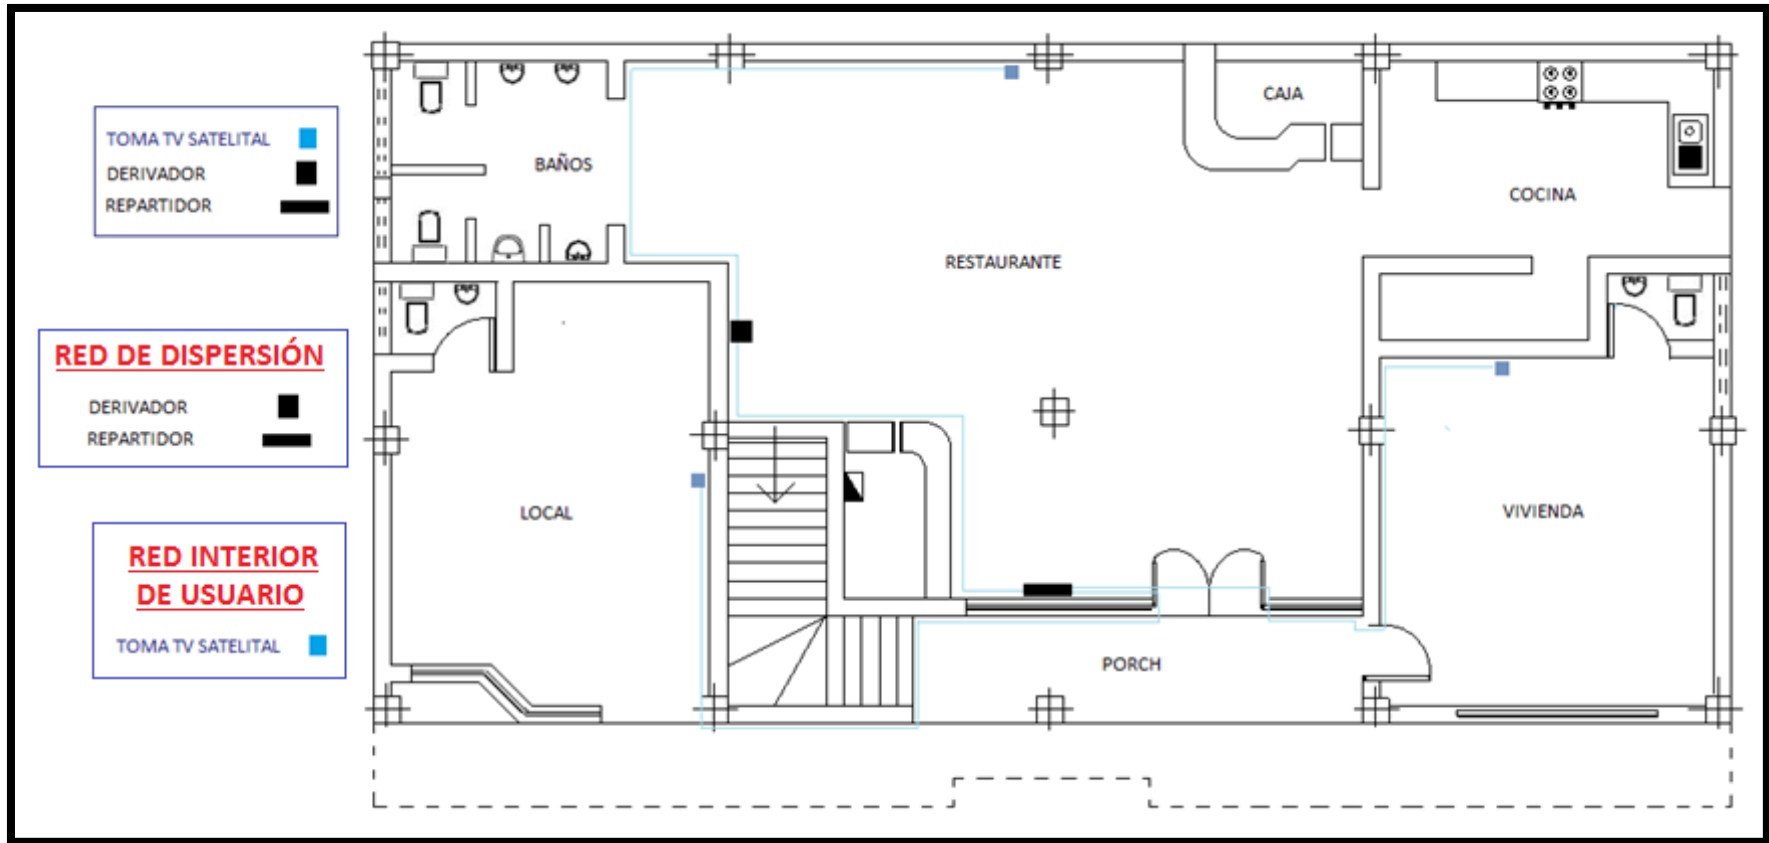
Puntos de TV satelital – Plano Planta Baja
